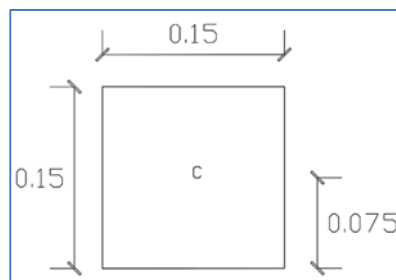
Sección transversal de las viguetas y ubicación del centroide (c)
